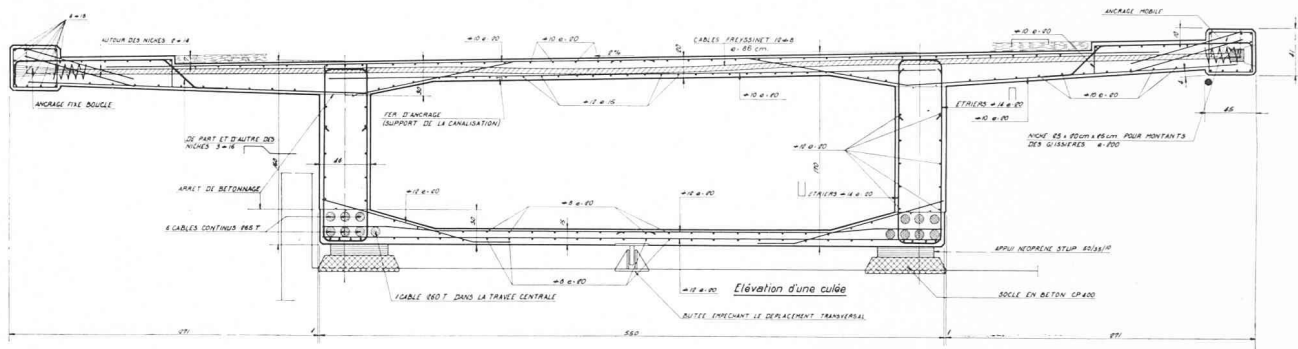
Coupe en travée. Détail. Élévation des appuis sur culée.
